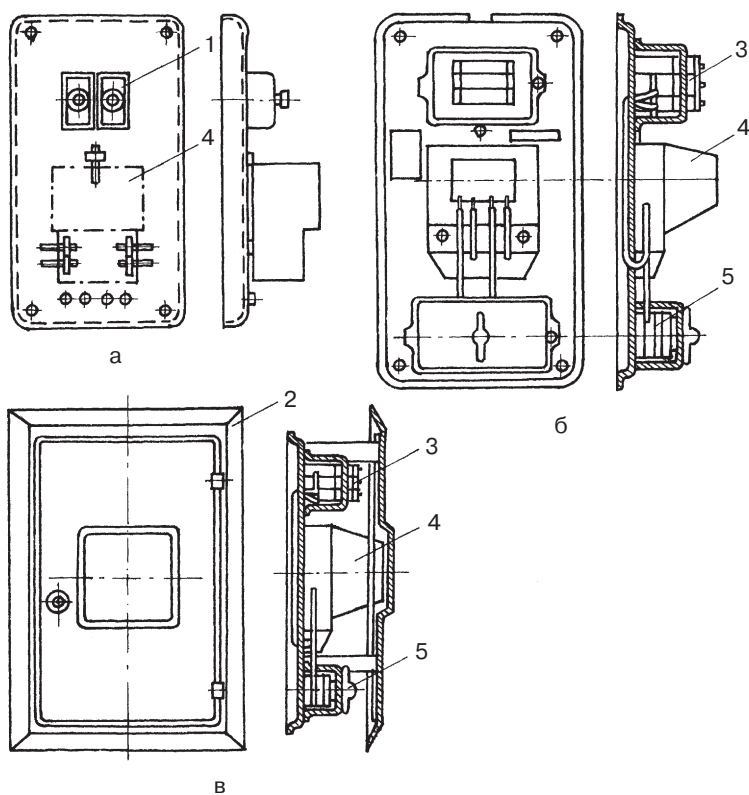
Распределительные щитки: а — ЩК-10; б — ЩК-2101; в — ЩК-1101 (1 — предохранители; 2 — обрамление; 3 — автоматические выключатели; 4 — счетчик; 5 — пакетный выключатель)
